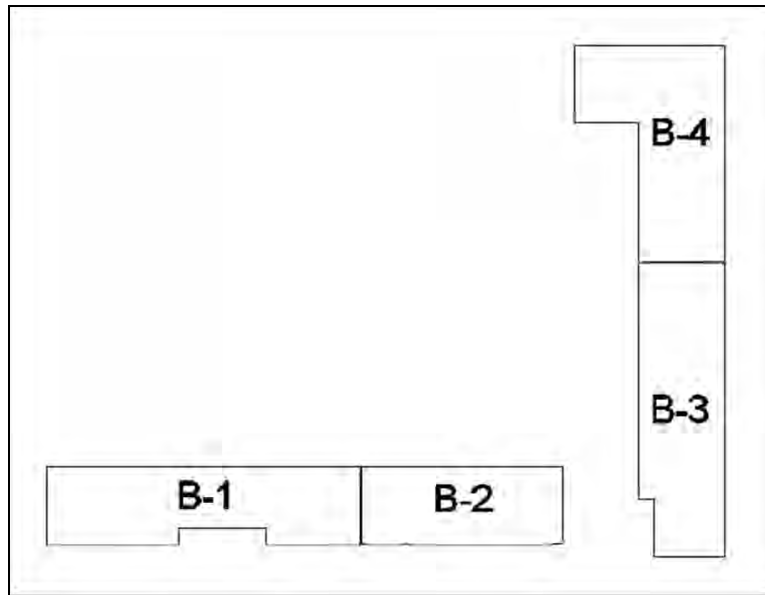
Planta esquemática Plaza de Mercado de Consacá existente.
